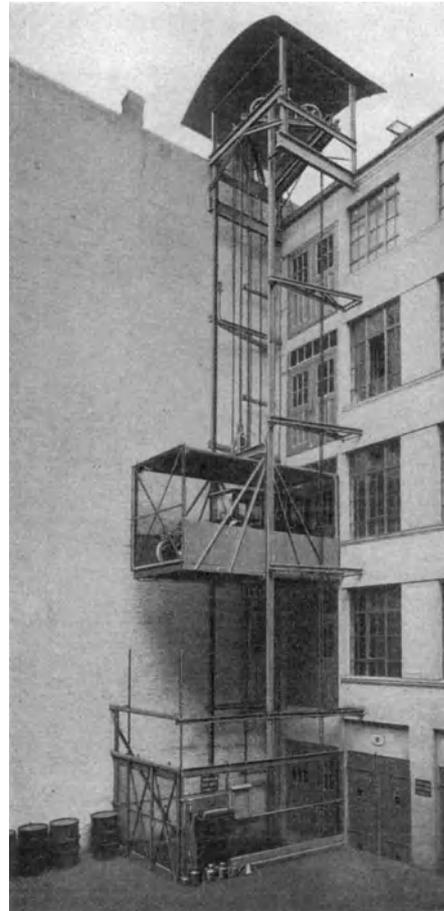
Schachtgerüst mit gesondert in der Gebäudemauer verankertem Rollengerüst.
